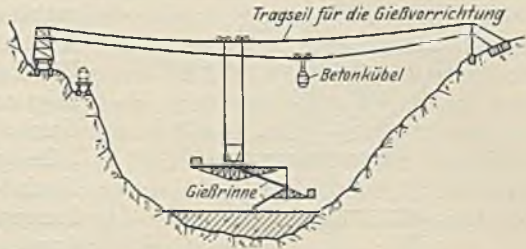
Kabelkran mit einem feststehenden und einem fahrbaren Turm in Verbindung mit einer schwenkbaren Gießvorrichtung (Patent Bauunion-Bleichert).
